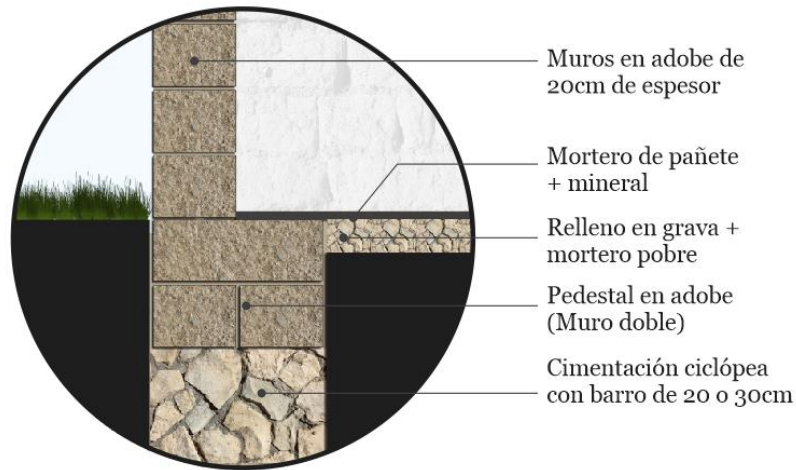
Detalle constructivo de las viviendas. Fuente: Elaboración propia, 2020. CC BY-NC 4.0
